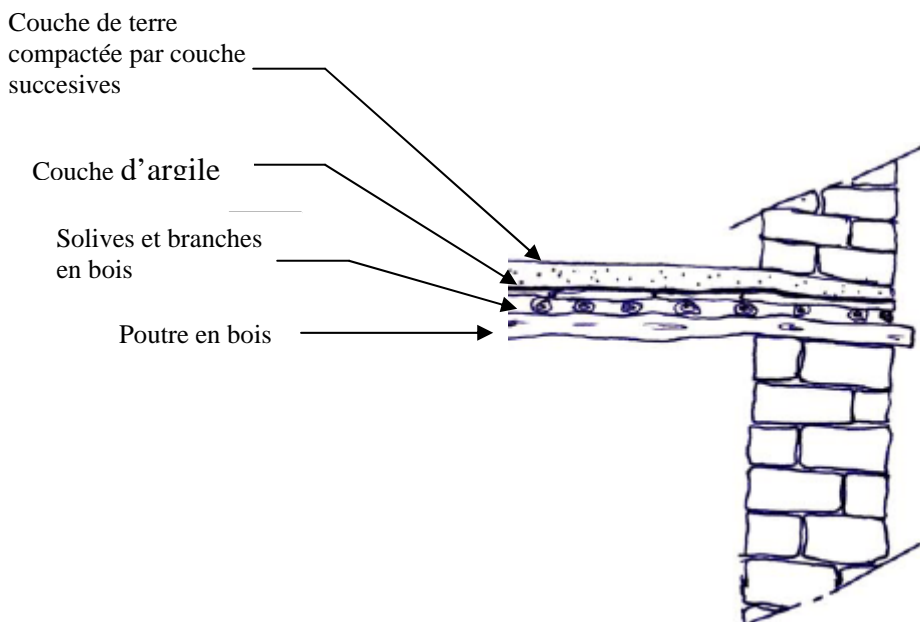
Détail de plancher pour une maison traditionnelle (source Auteur)
